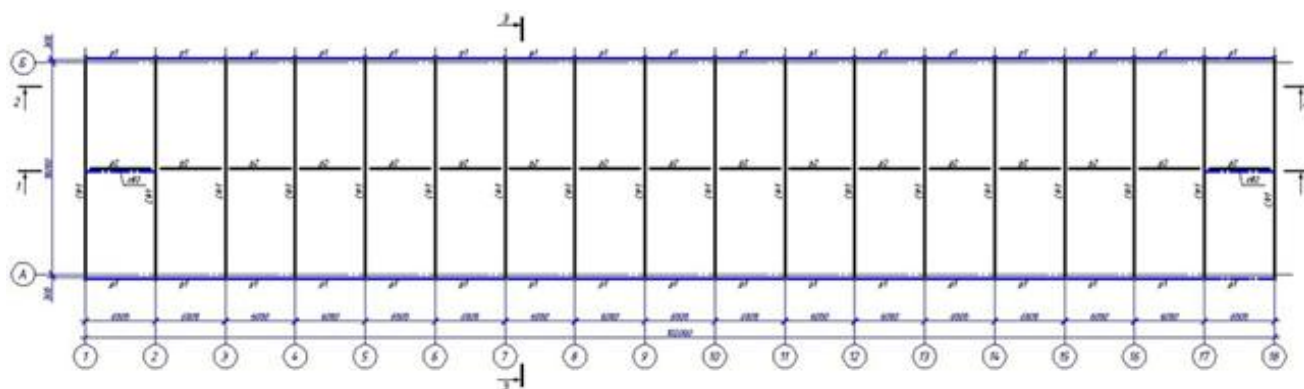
Схема розташування кроквяних ферм і зв'язків на рівні нижнього пояса ферм
